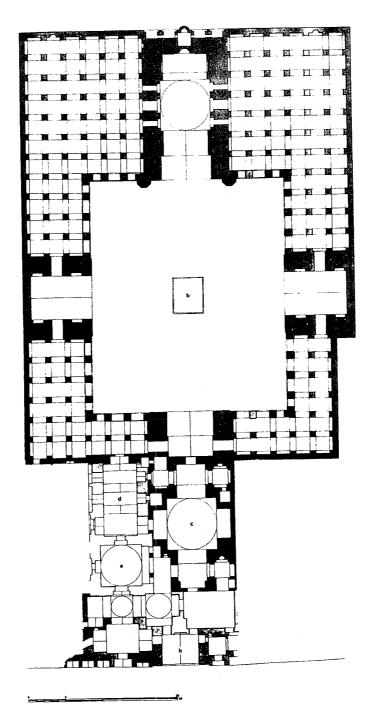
مسقط أفقي لمسجدملك في كرمان . (عن : بوب) .
